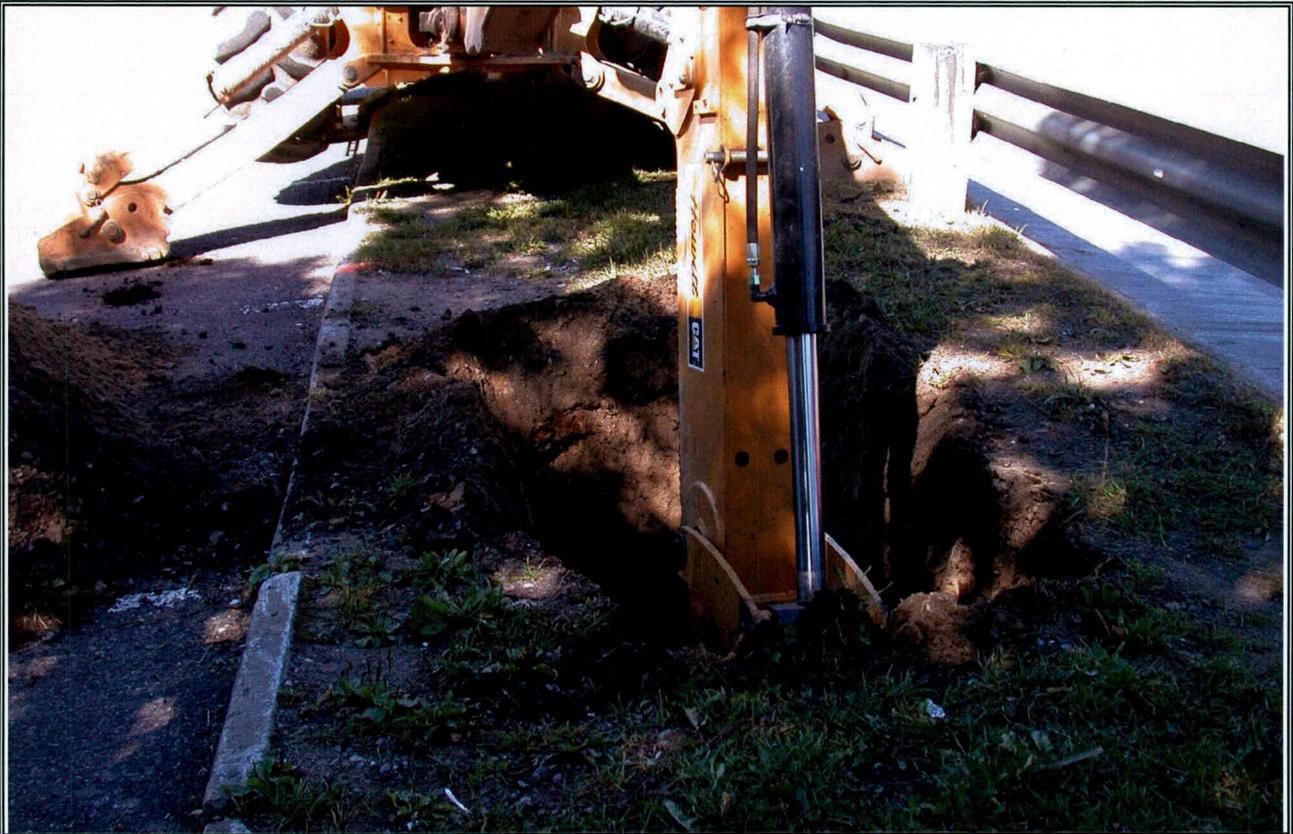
Projet n° 154-00-1342, forage 5 (S)
